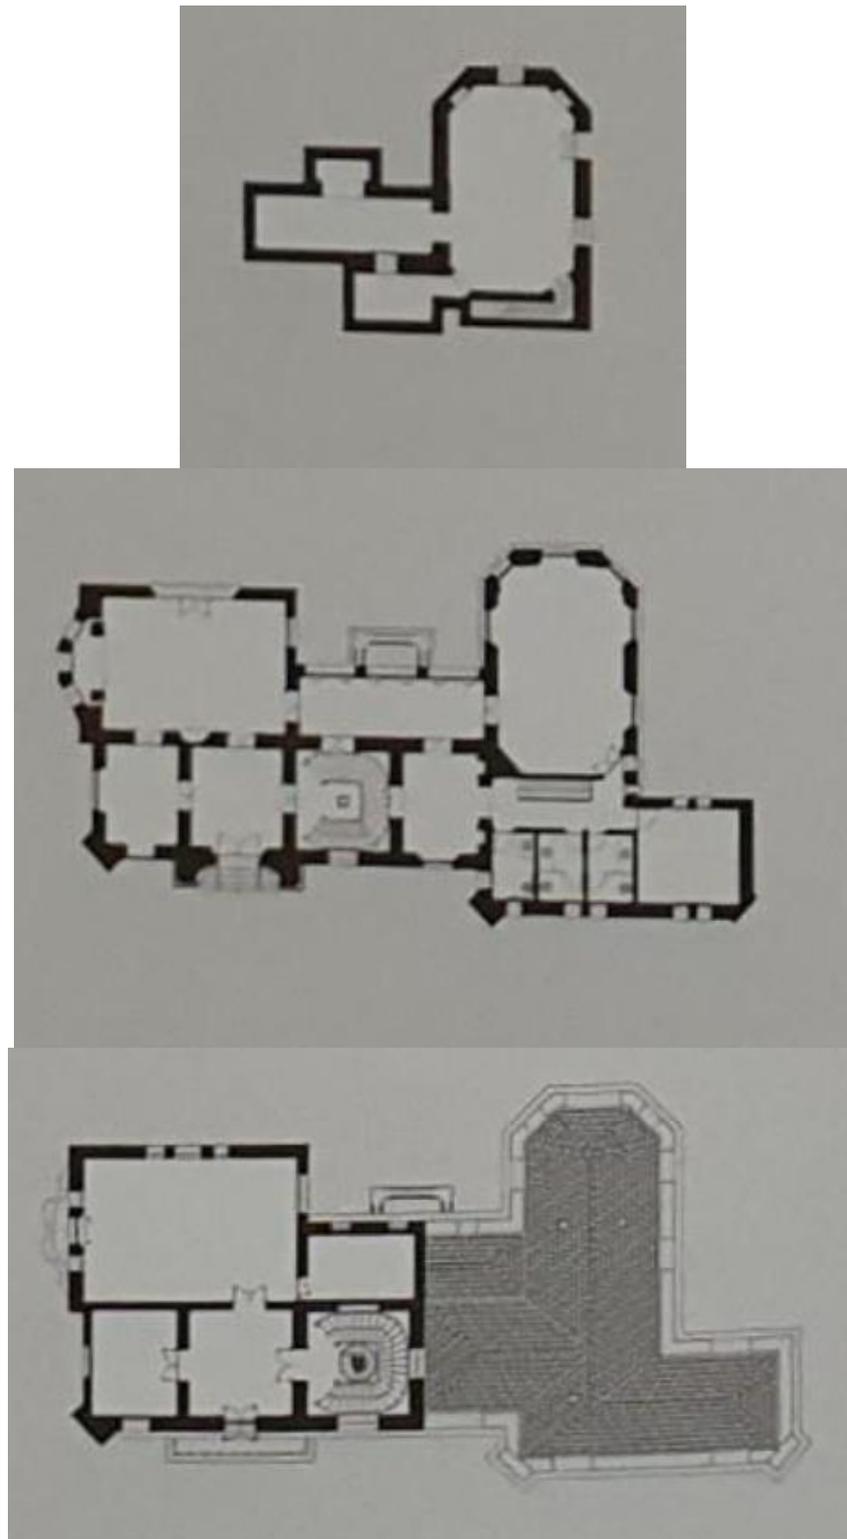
Projeto do Palacete elaborado pelo Escritório Kruchin Arquitetura – Plantas baixas
